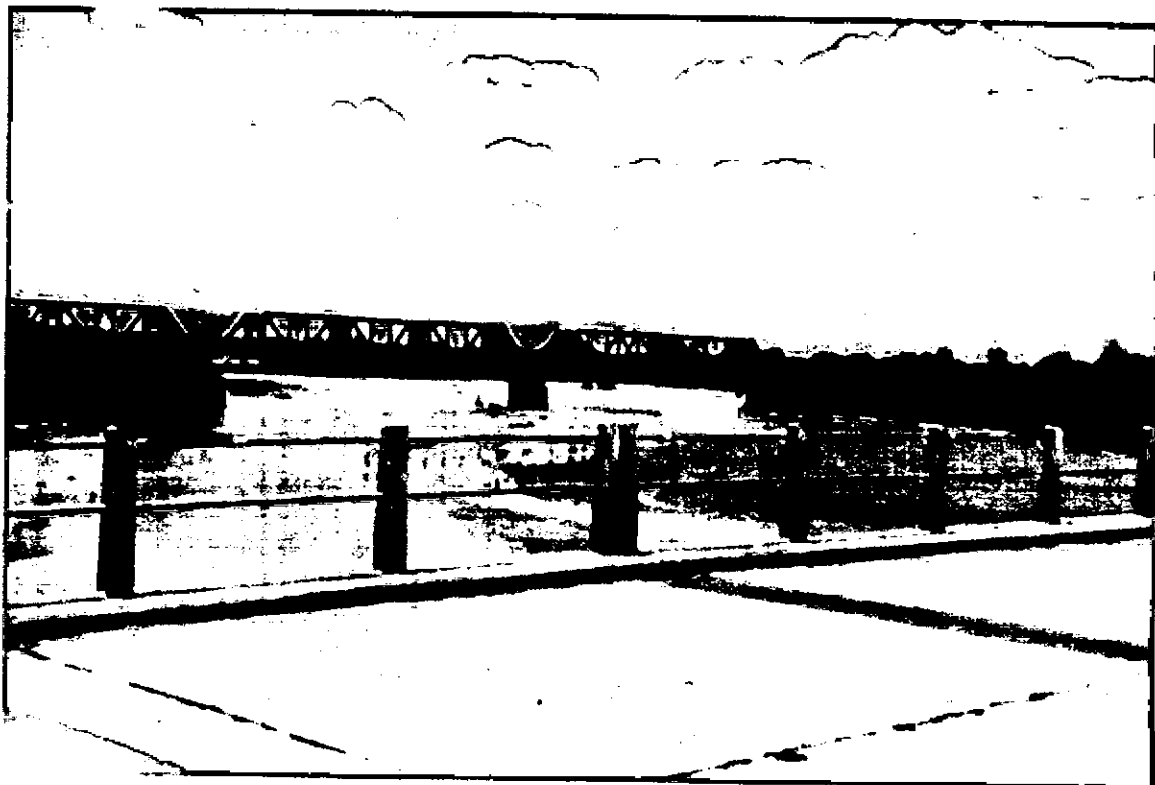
Puente ferroviario (F.C.M.G.B.) visto desde el puente caminero.
